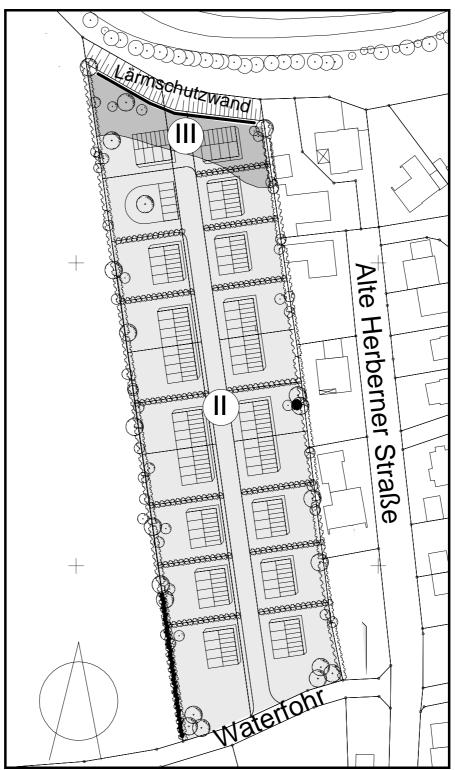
Beurteilung mit alternativer 5 m hoher Lärmschutzwand, Lärmpegelbereiche Obergeschoss / Dachgeschoss, Maßstab 1:1250
